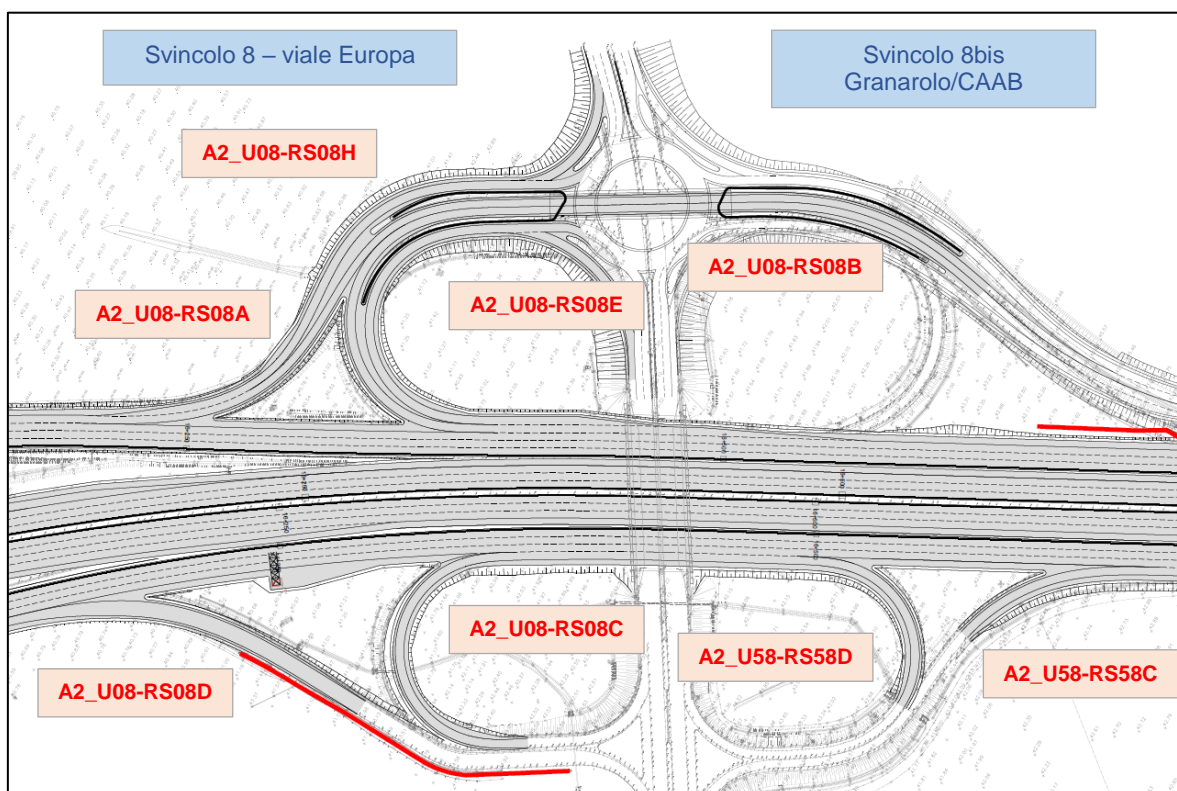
Stralcio planimetrico svincolo n.8 e 8bis
